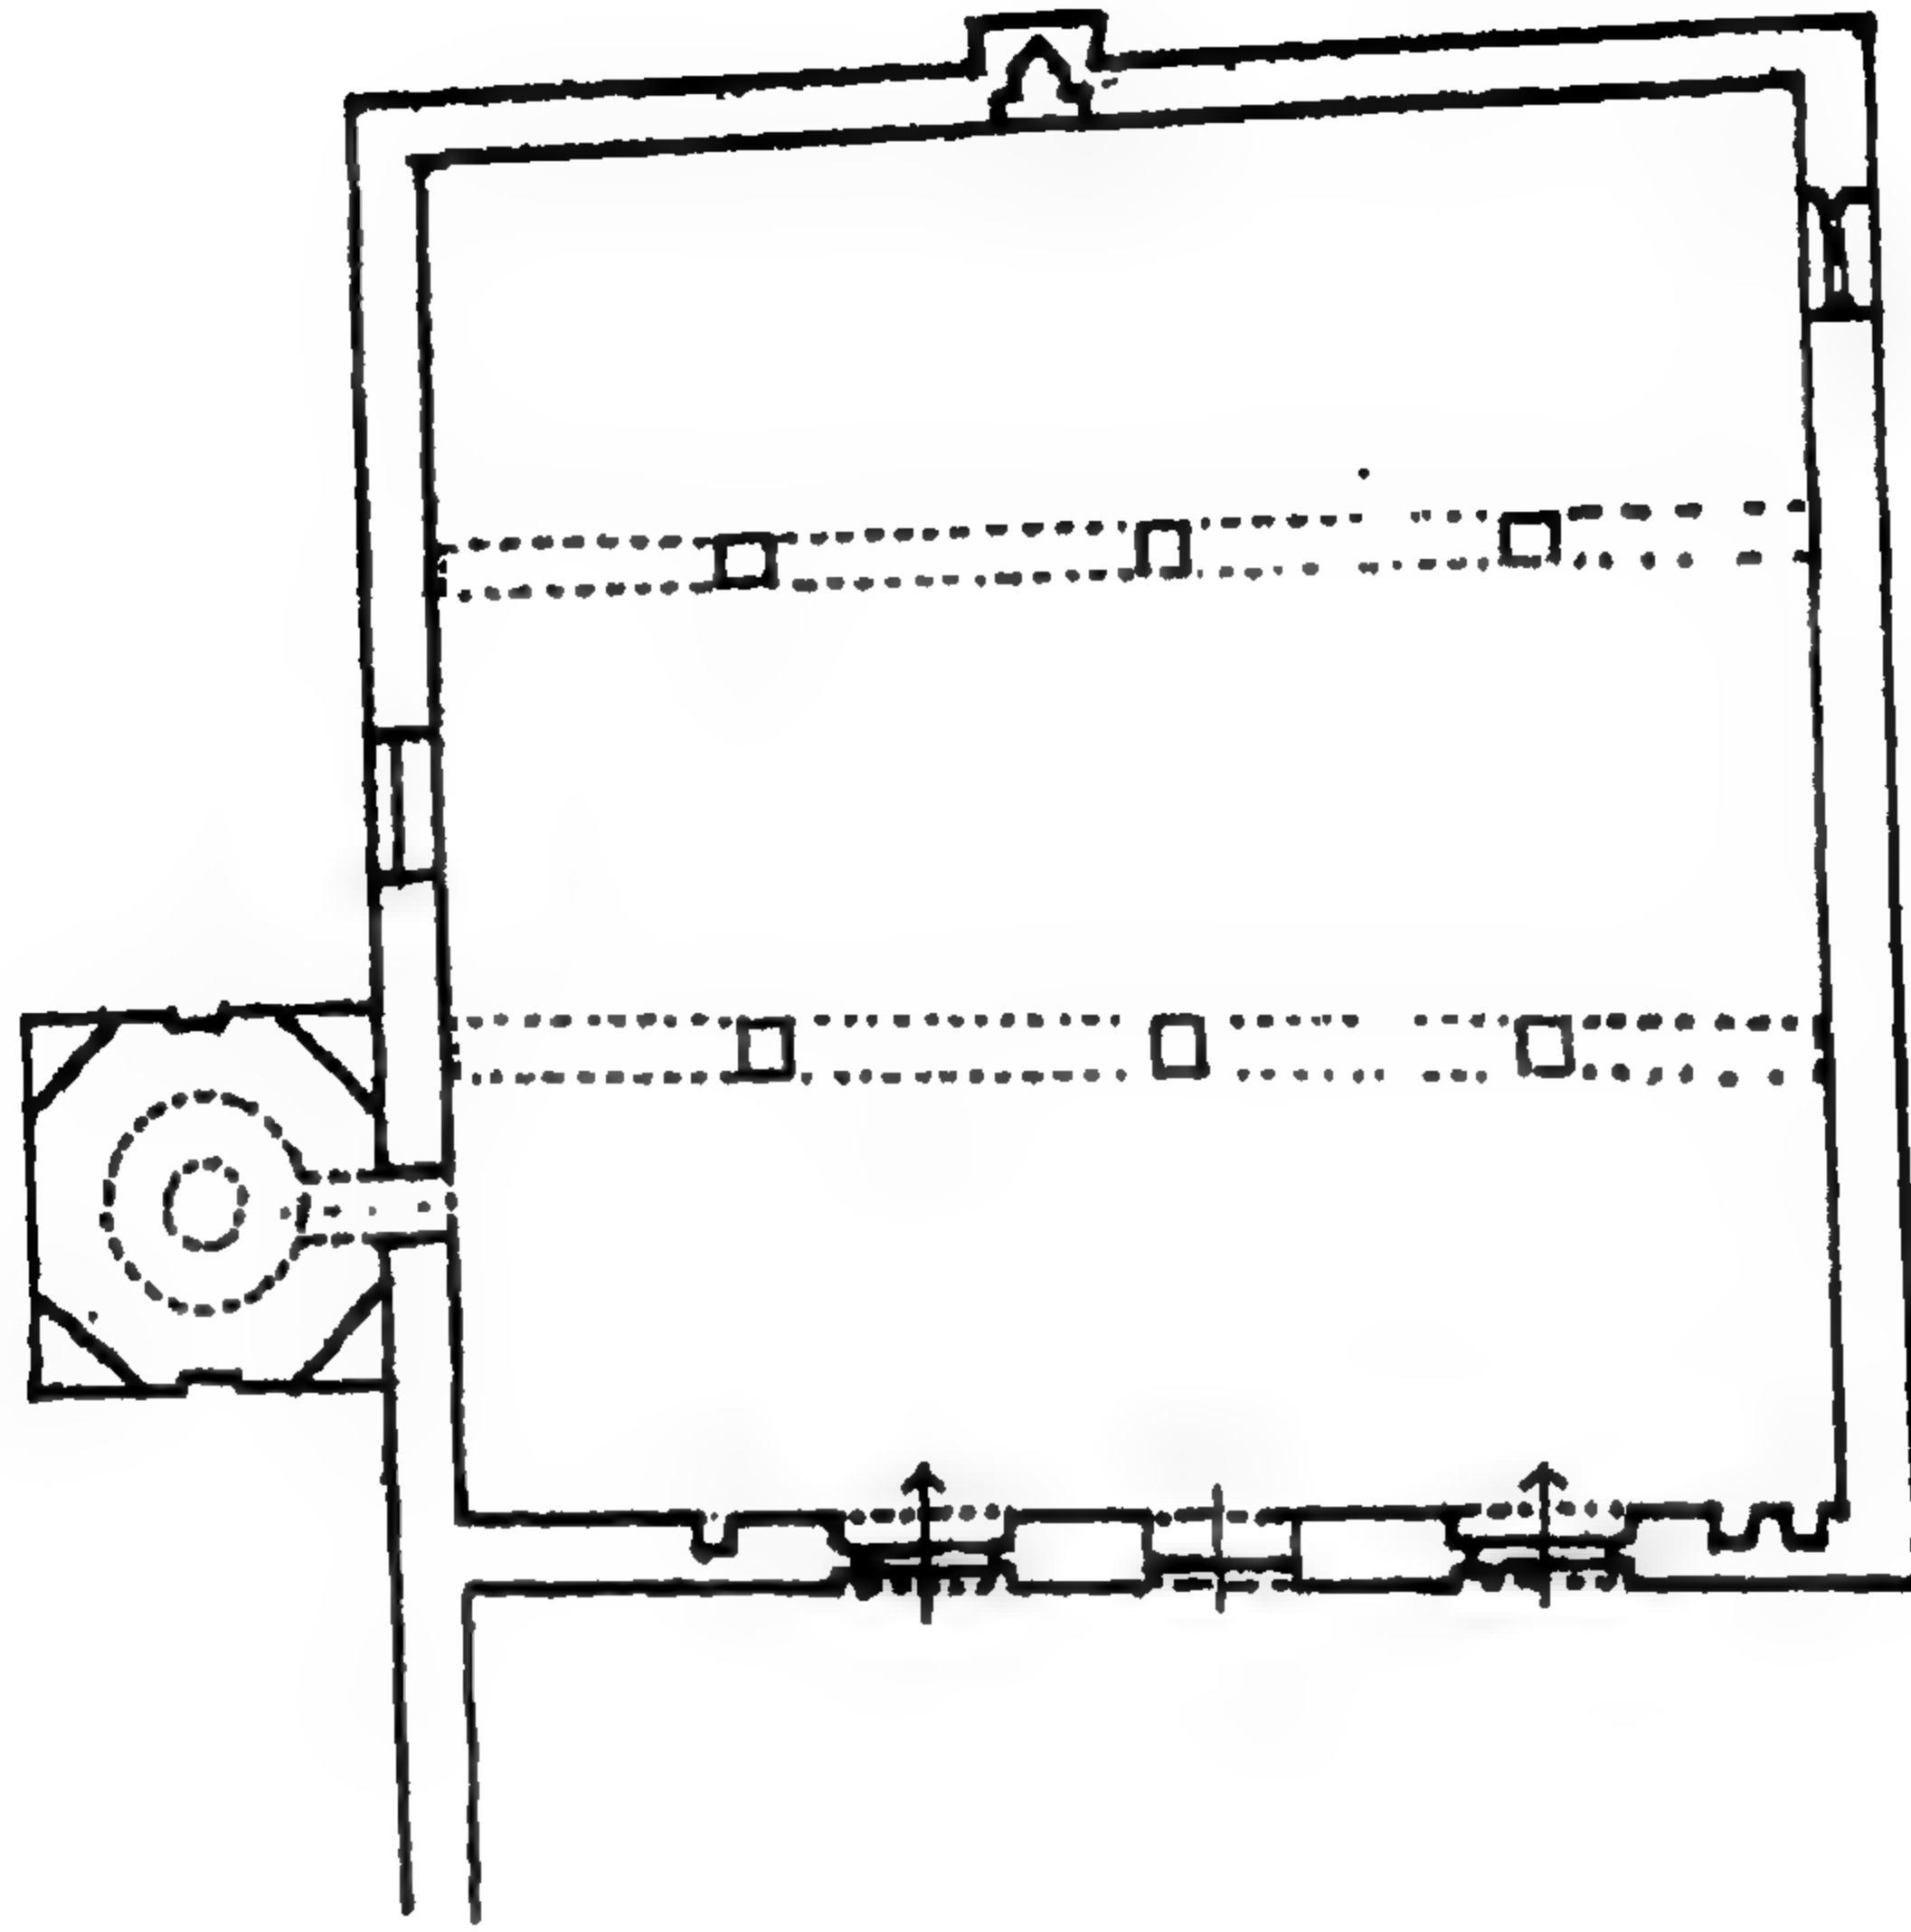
مسقط أفقي يبين المرحلة الأولى للجامع الكبير (عمل الباحث)
